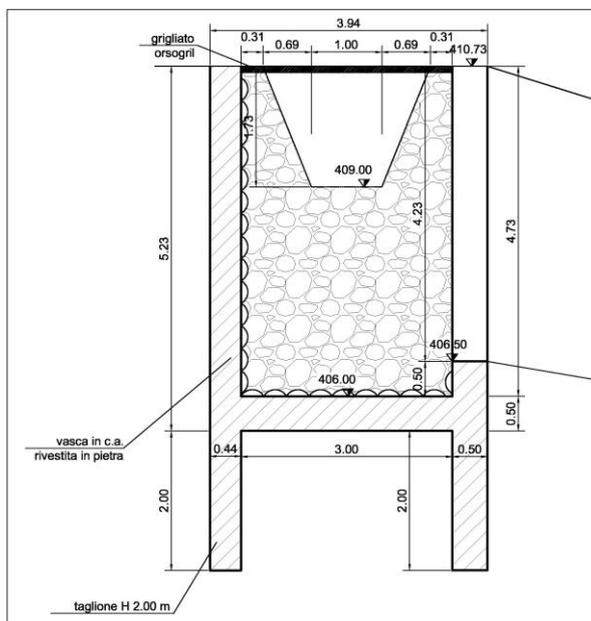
Compluvio centrale – Vasca Vi5 - sezione
